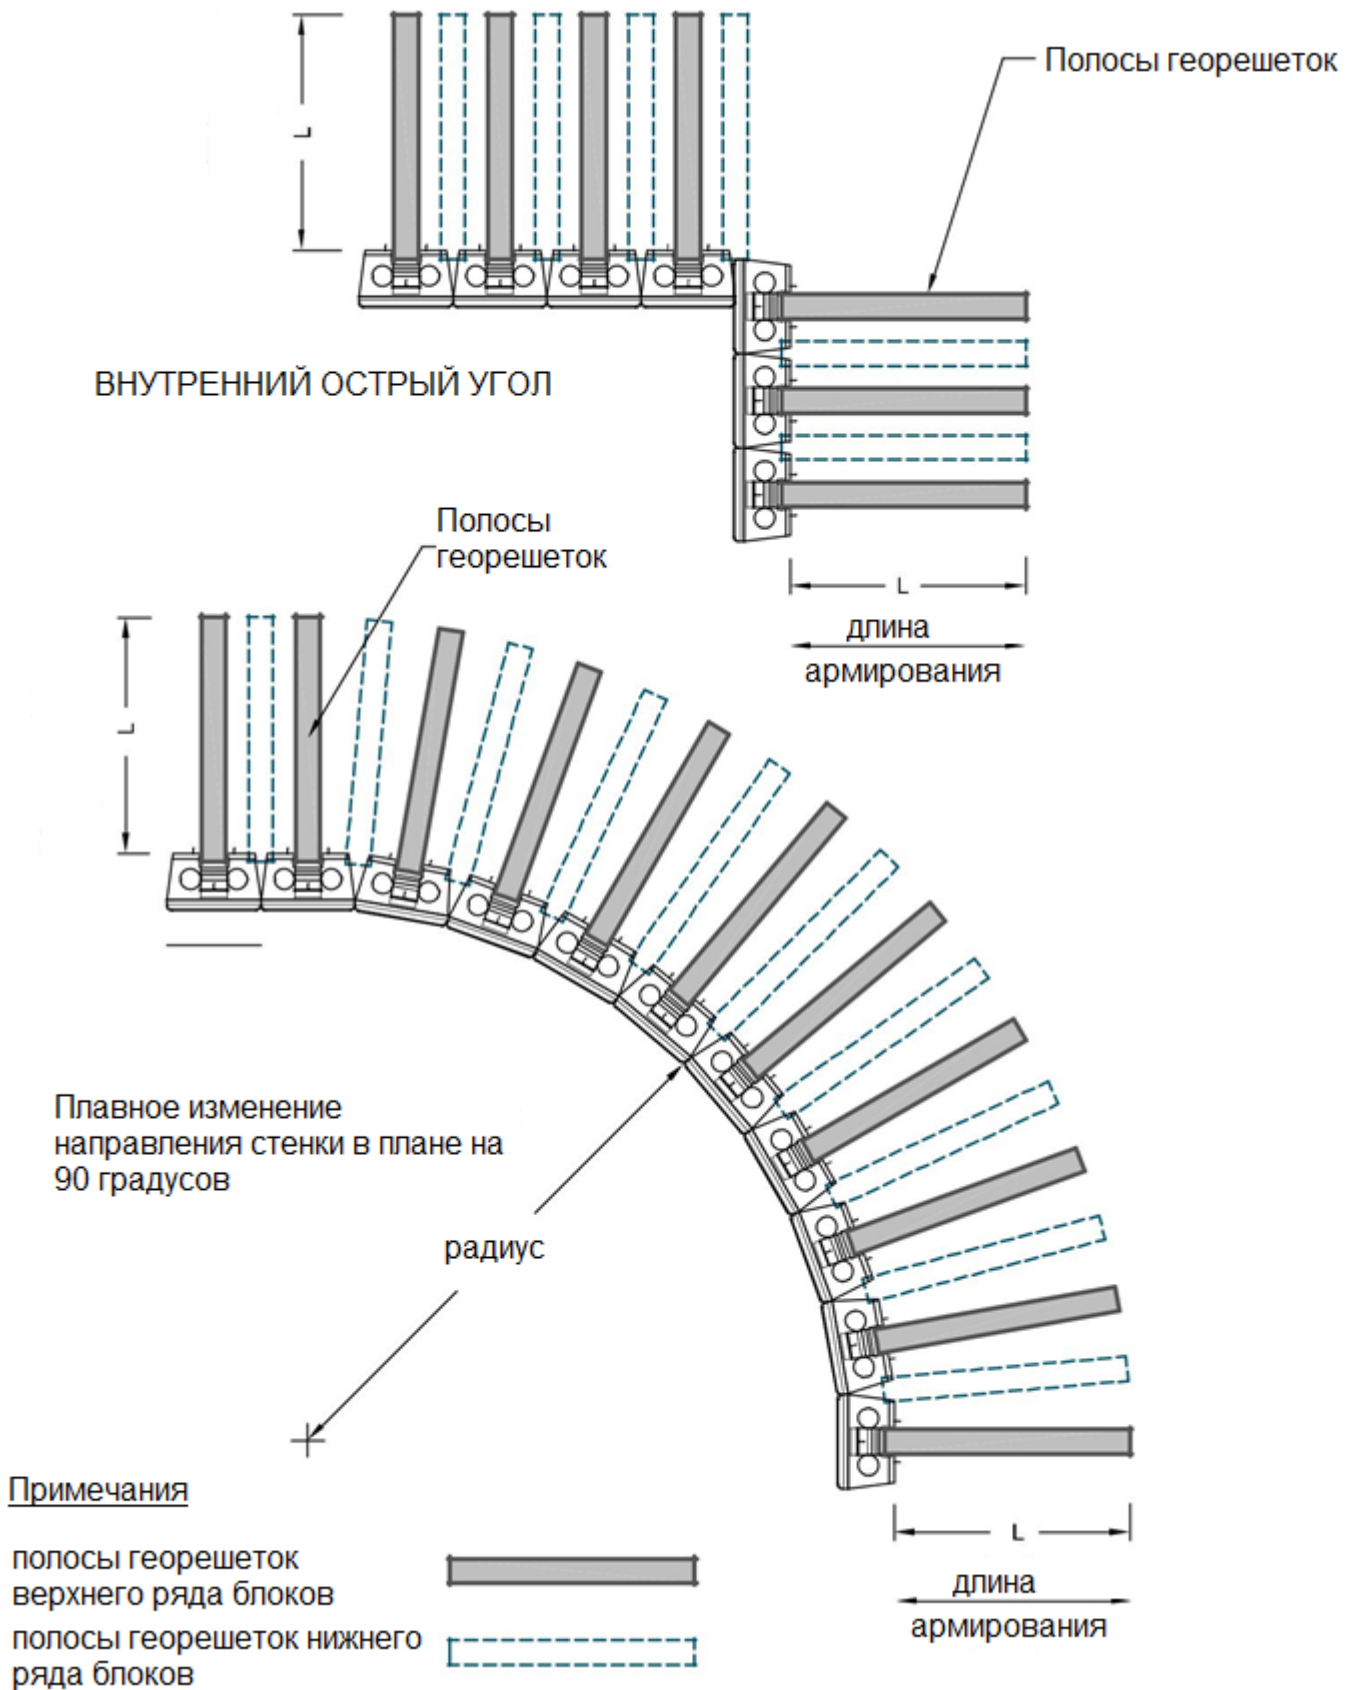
Расположение армирующих георешеток в стенках типа АГ 1 с внутренними углами поворотов в плане
